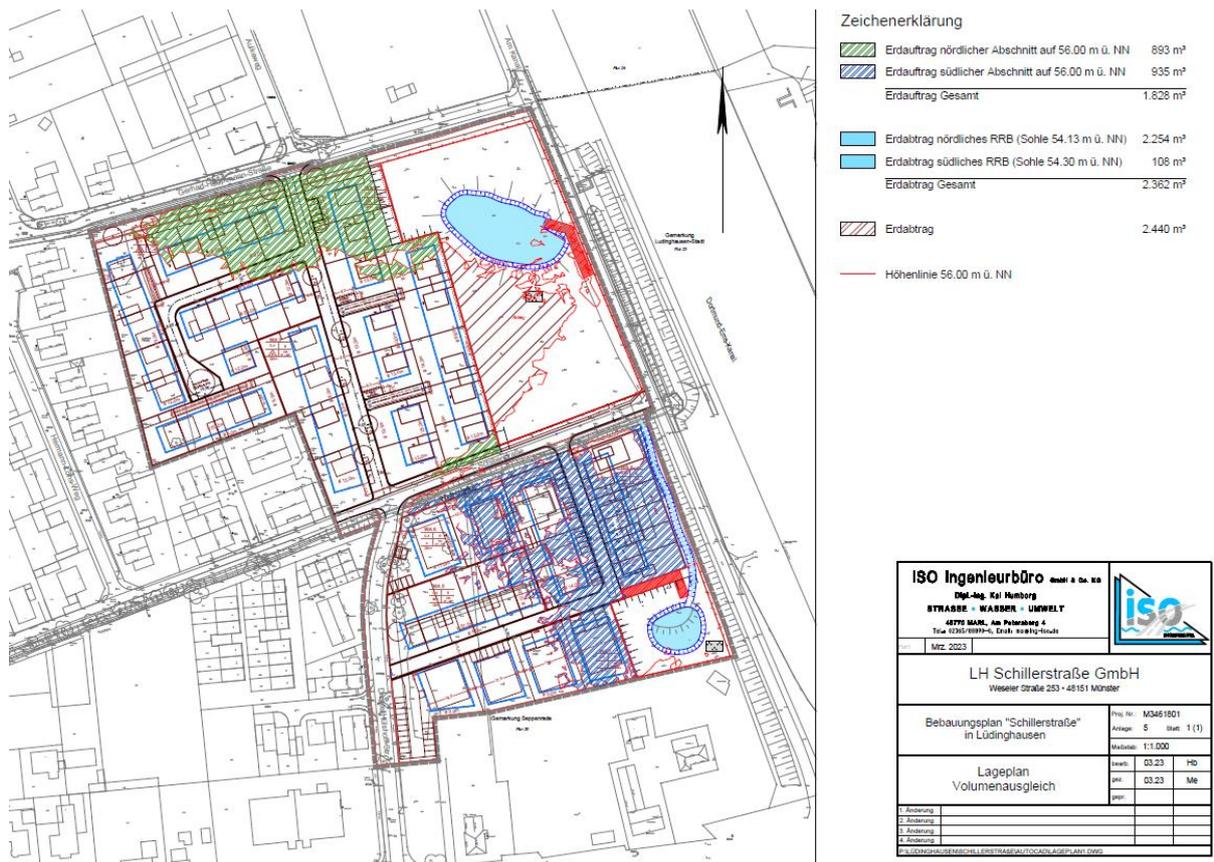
Lageplan Geländemodellierung und Hochwasserschutz (ISO Ingenieurbüro)
